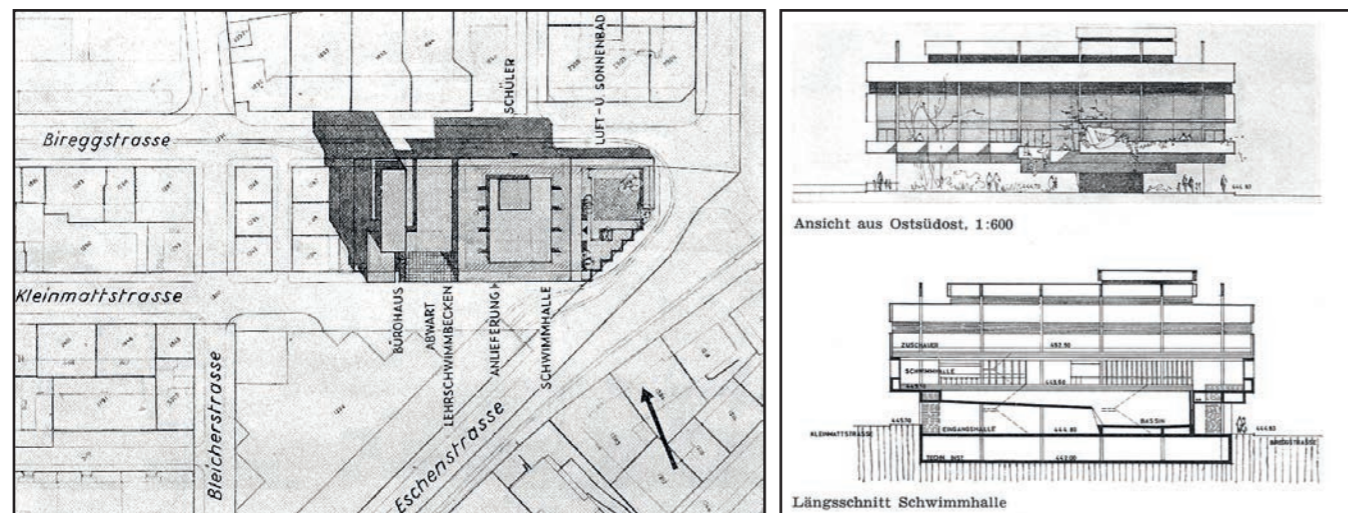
Links der Lageplan des Hallenbads im Wettbewerbsentwurf von Ammann-Stebler 1962 mit Sonnenterrasse und Hochhaus. Gekennzeichnet sind die verschiedenen Funktionen und Zugänge zum Gebäude. Rechts Frontansicht und Längsschnitt der grossen Schwimmhalle des Wettbewerbsentwurfs. Schweizerische Bauzeitung 20 (1962), Nr.19. S.324.
